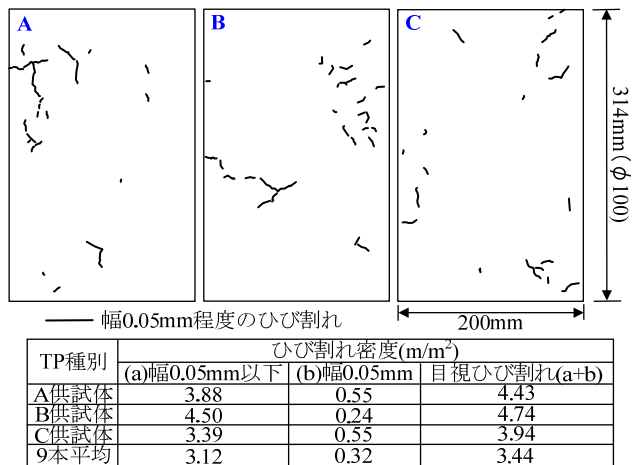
テストピース側面のひび割れ状況(展開図)
